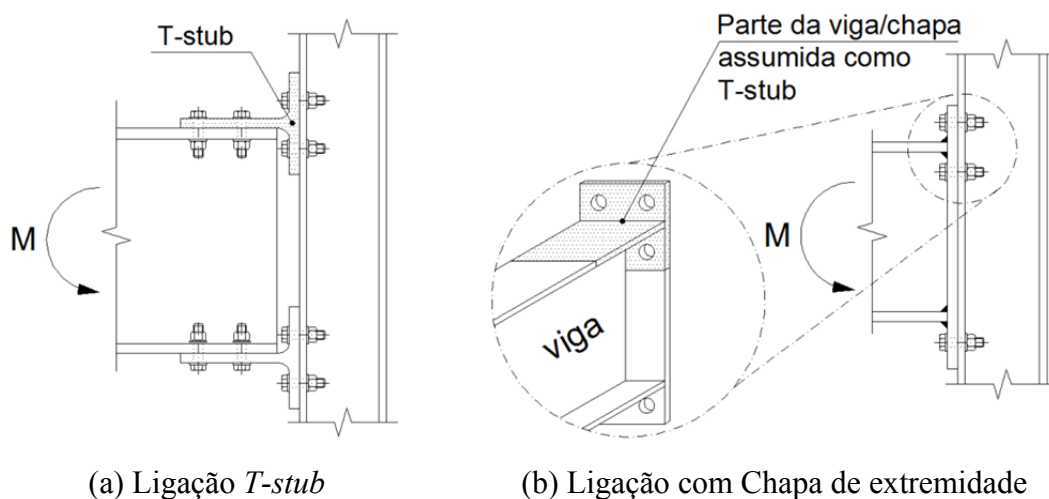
Ligações viga-pilar que utilizam peças de ligação de seção T
